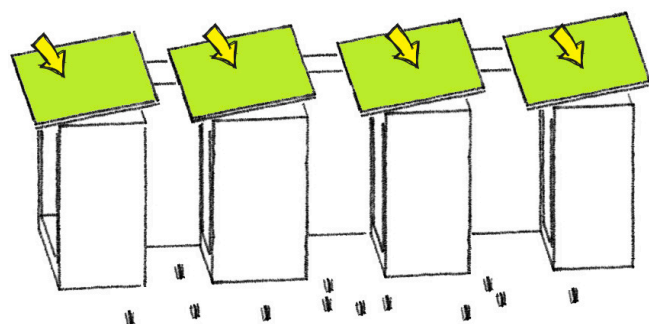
Cubierta inclinadas al sur. Autoría propia.
